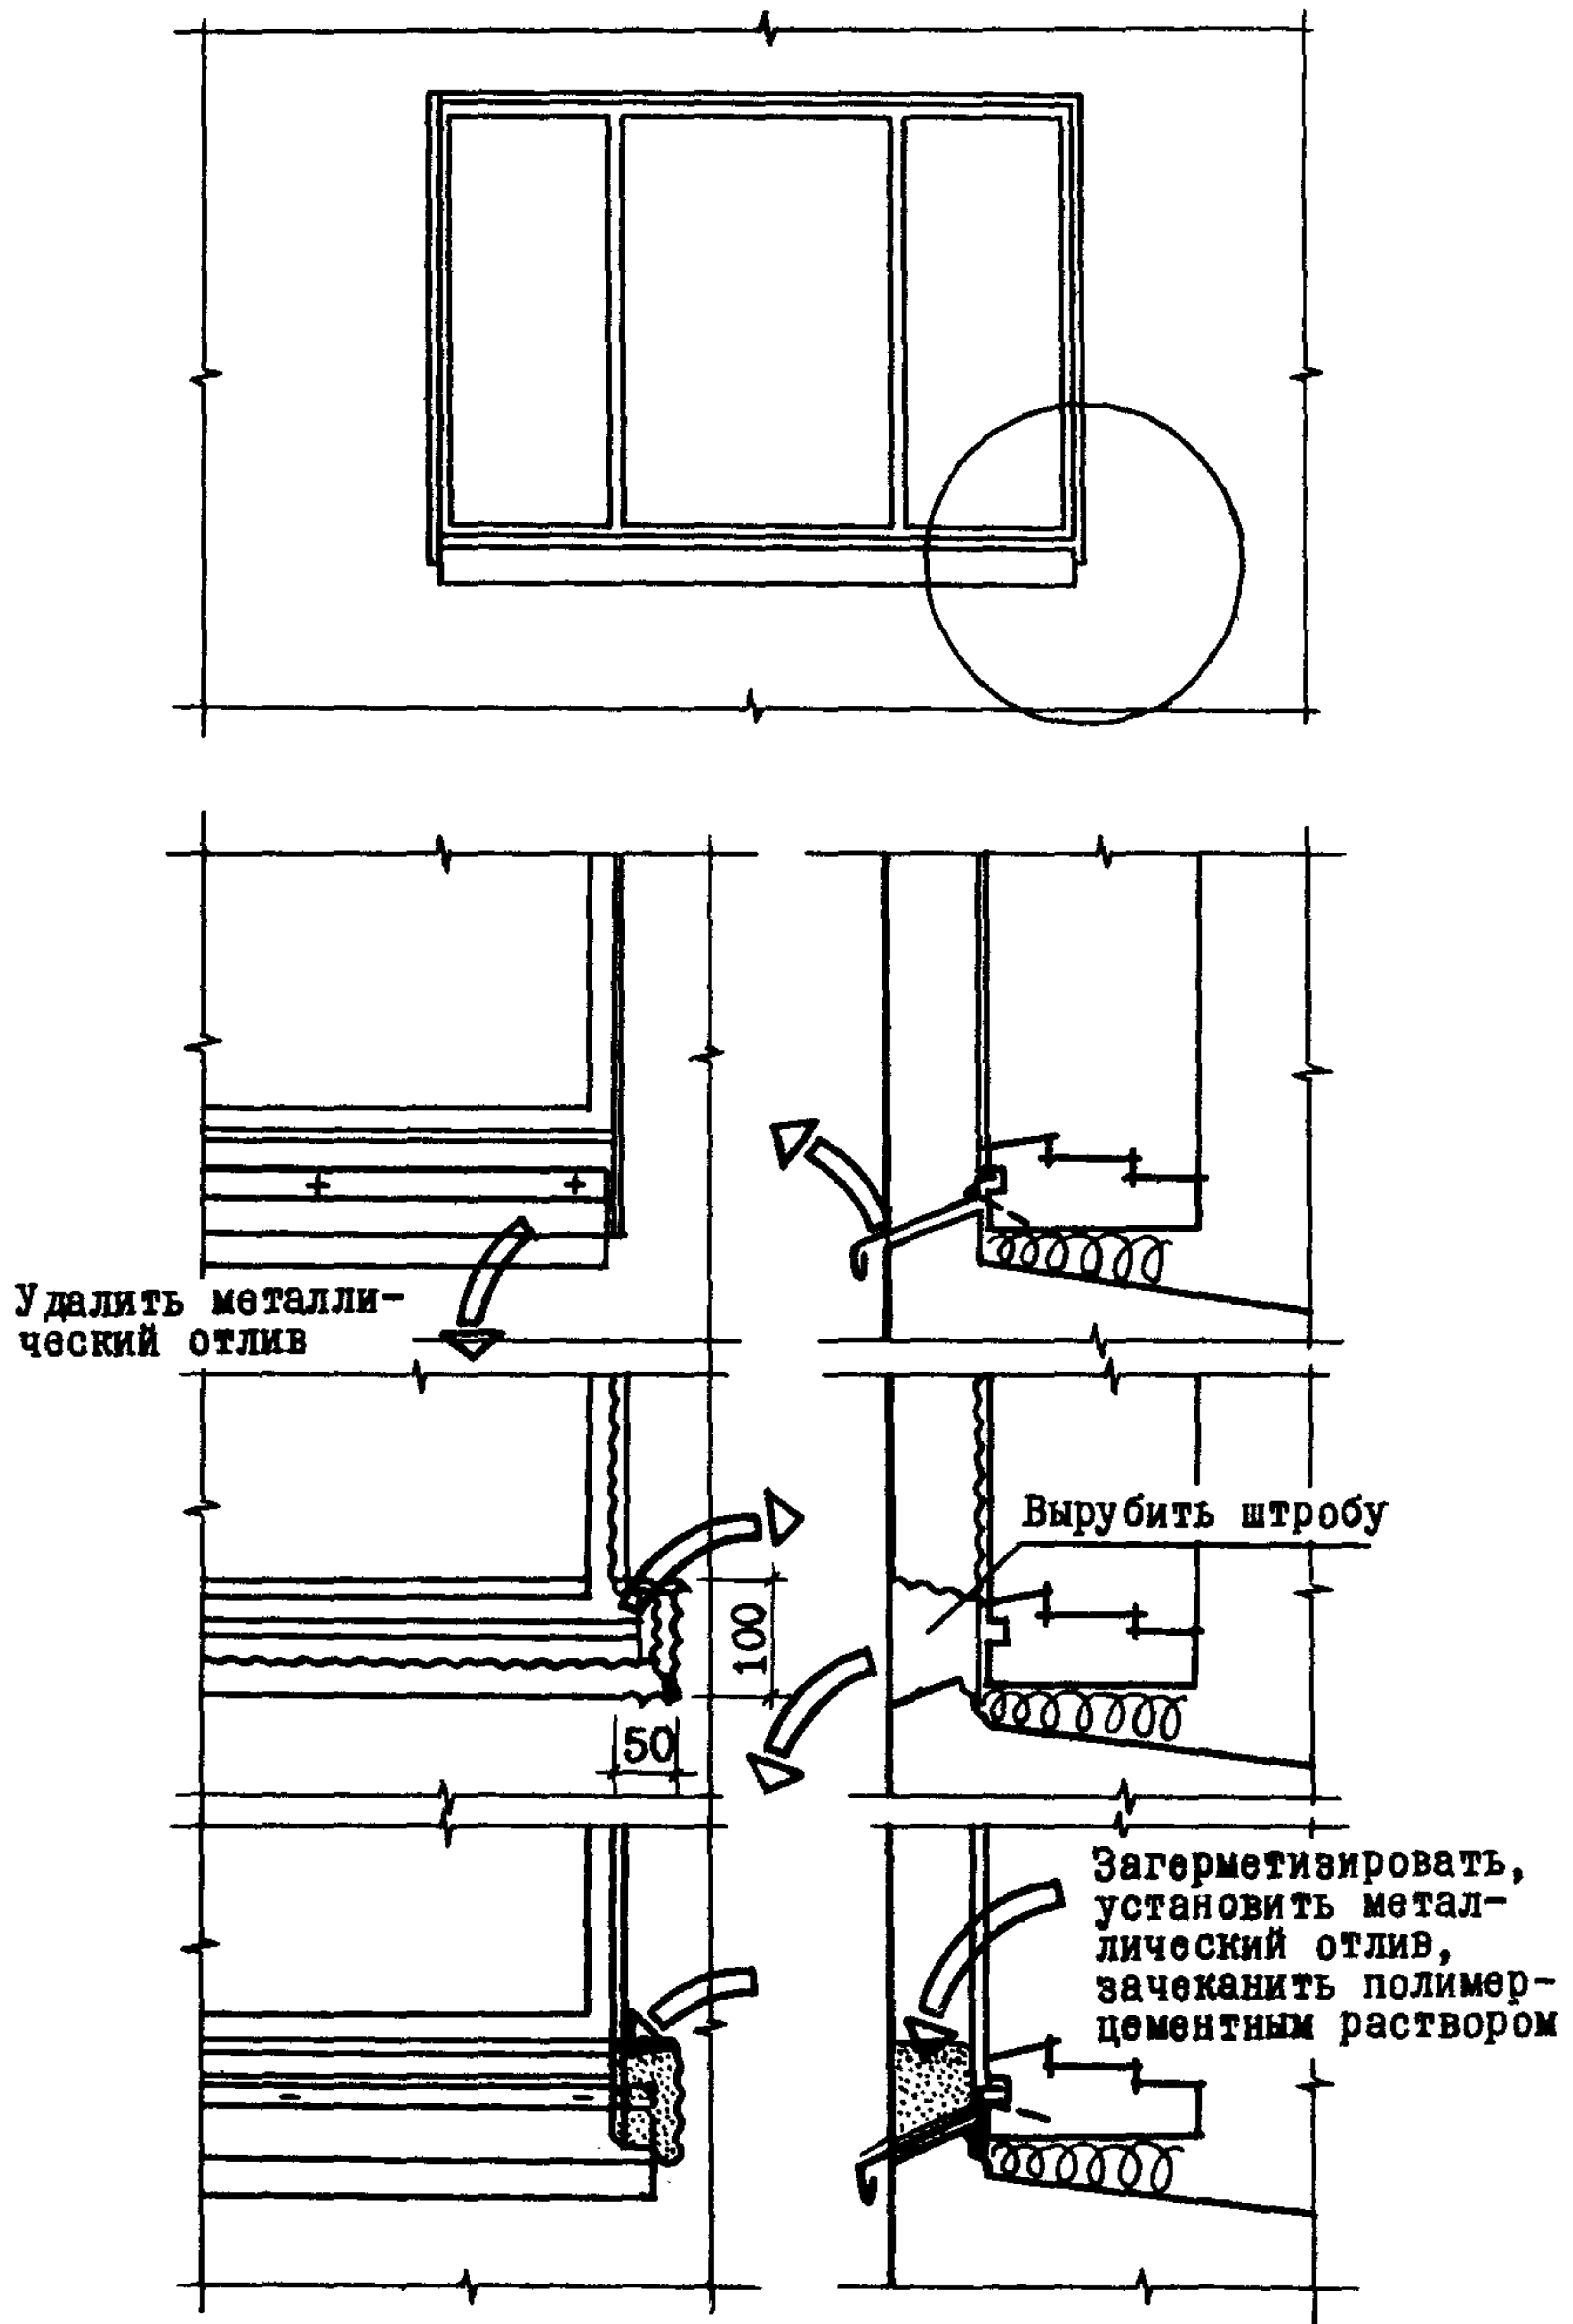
Ремонт мест примыканий оконных заполнений к проемам со стороны фасада
